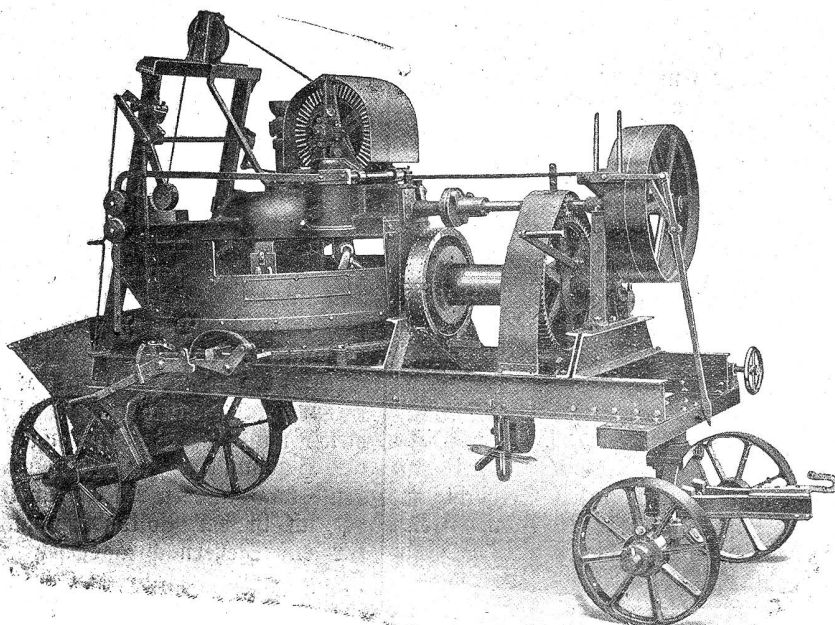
Fahrbare Betonmischmaschine „Pat. Girich“ verbunden mit Bauwinde.
